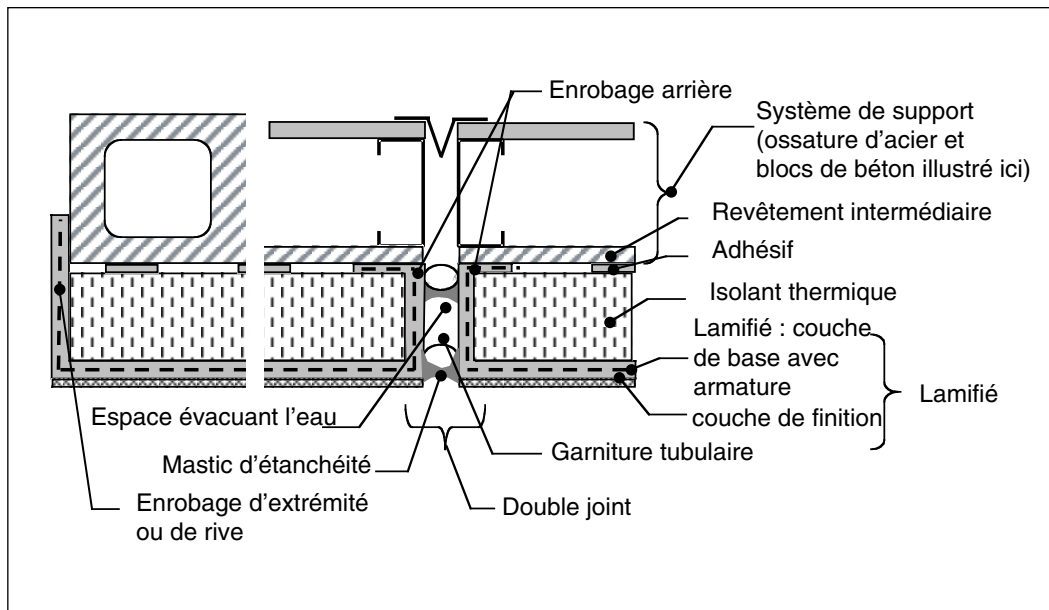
Système d'étanchéisation de façade avec joint d'évacuation de l'eau
